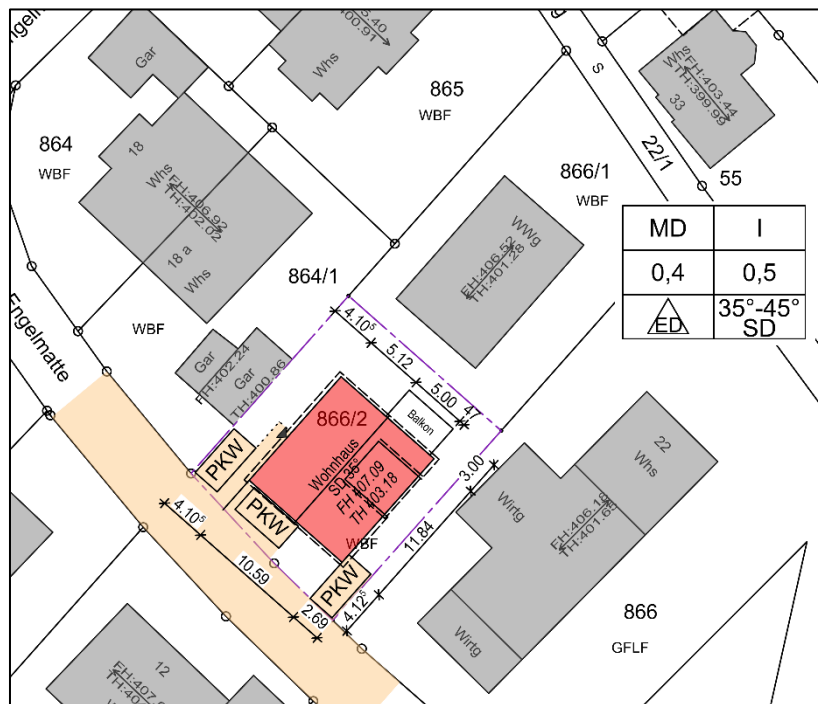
Lageplan zum Bauvorhaben Lorenz in Wittgau. (Stand Januar 2021)
